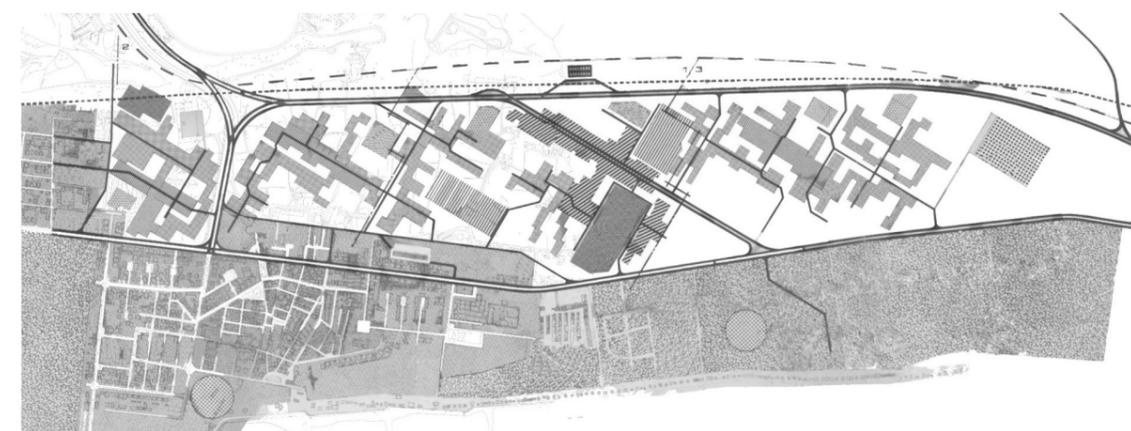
PLANTA GERAL DO PLANO DE URBANIZAÇÃO
